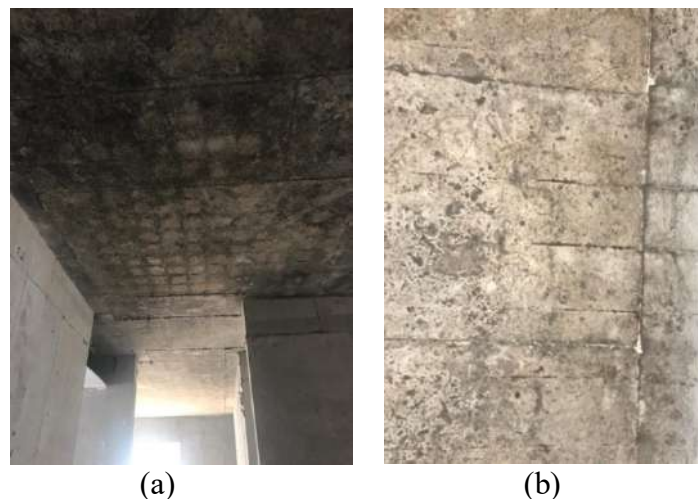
Cobrimento insuficiente das armaduras no fundo de laje (a) e em parede (b) da Obra A.
